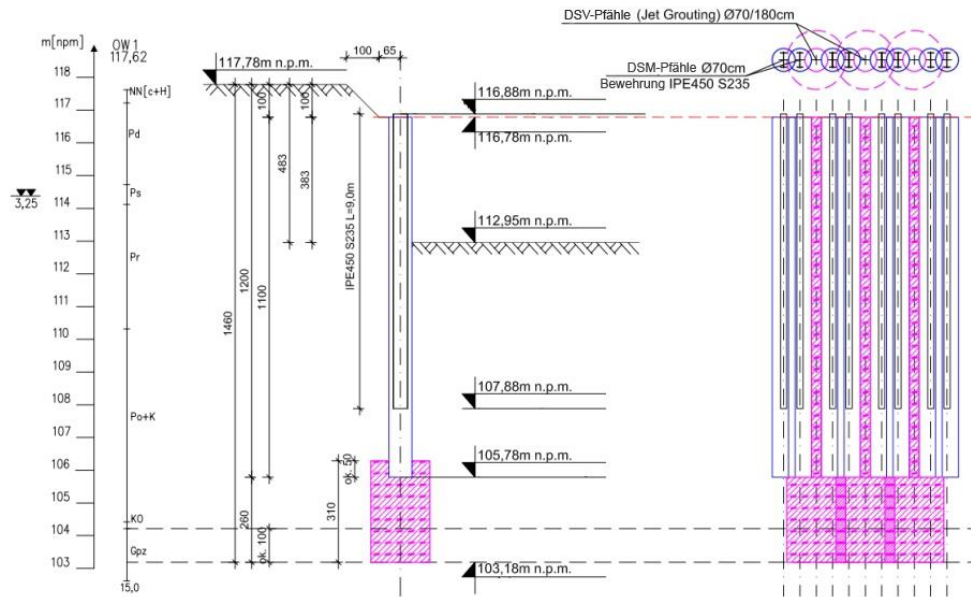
Pläne der Baugruben-absicherung, Schnitt und Übersicht im Grundriss
